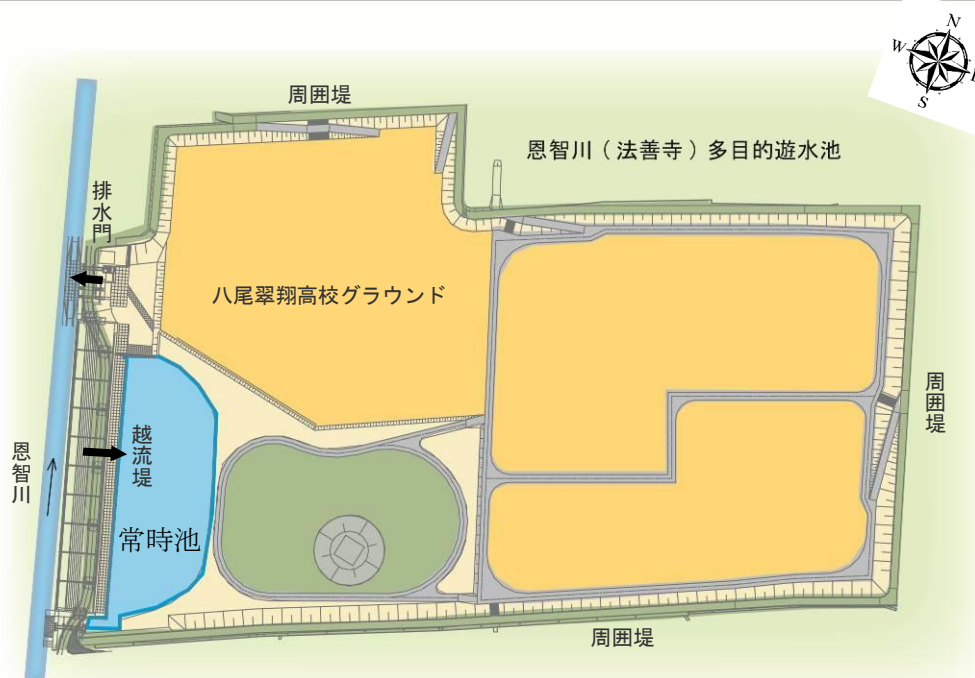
恩智川(法善寺)多目的遊水地 平面図
